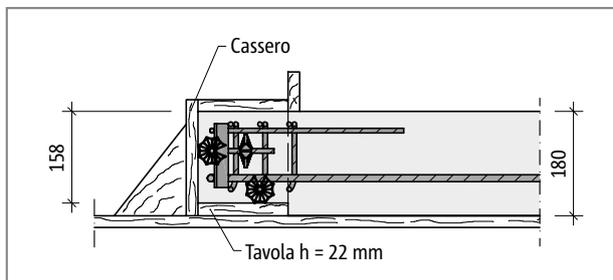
Schöck Tronsole® tipo Z, esecuzione di una mensola d'appoggio sul pianerottolo prefabbricato; spessore del pianerottolo $h = 180$ mm
